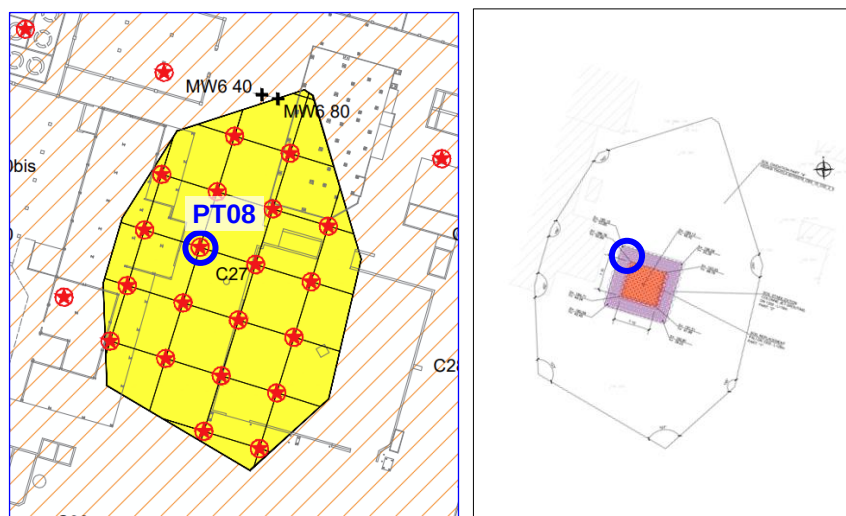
Estratto dalla Figura 01 - Indagini propedeutiche alla realizzazione degli interventi di bonifica della Reazione illustrativa del Progetto Definitivo (a sinistra) e dalla tavola Area di MISP - Interventi di bonifica profonda Pianta e sezioni tipo - Tavola 2 di 2 (a destra), con indicazione del punto di esecuzione del carotaggio
